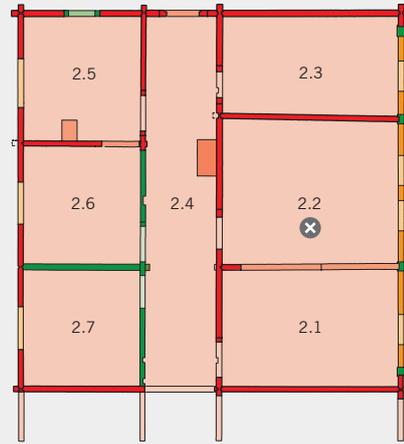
Unterägeri, Chammersbüel, Grundriss des zweiten Vollgeschosses.
